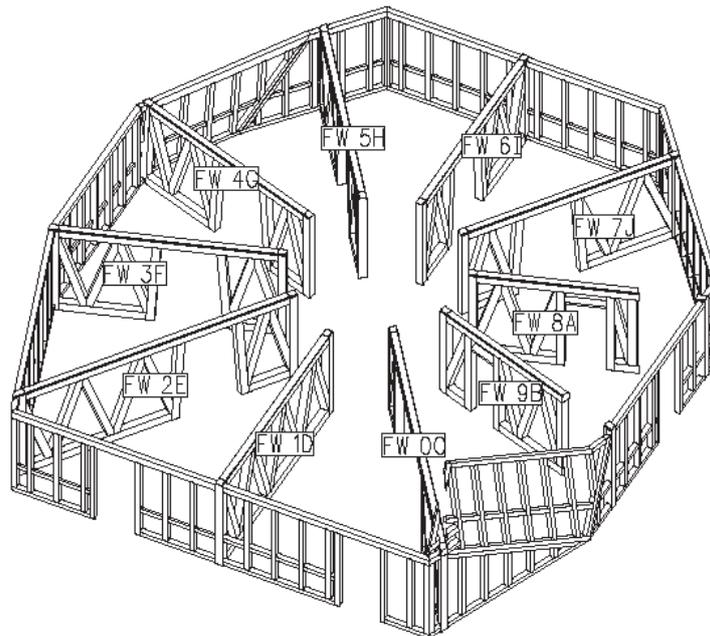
Wände im Erdgeschoss. Im Vordergrund die Südfassade
